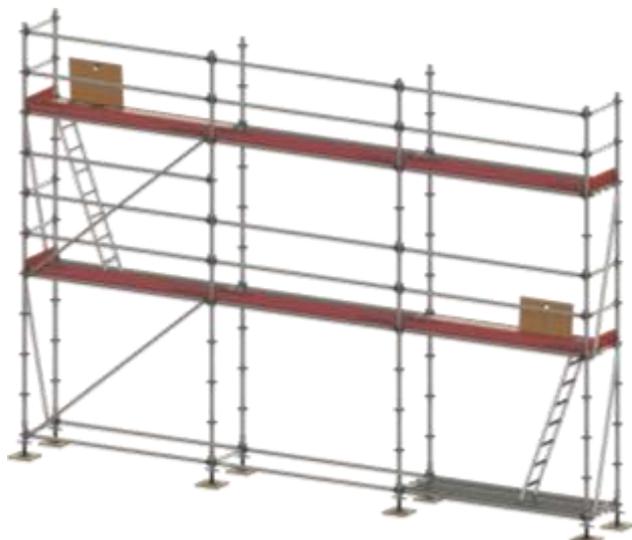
Diagonale horizontal en cas de plateformes à planches en bois
